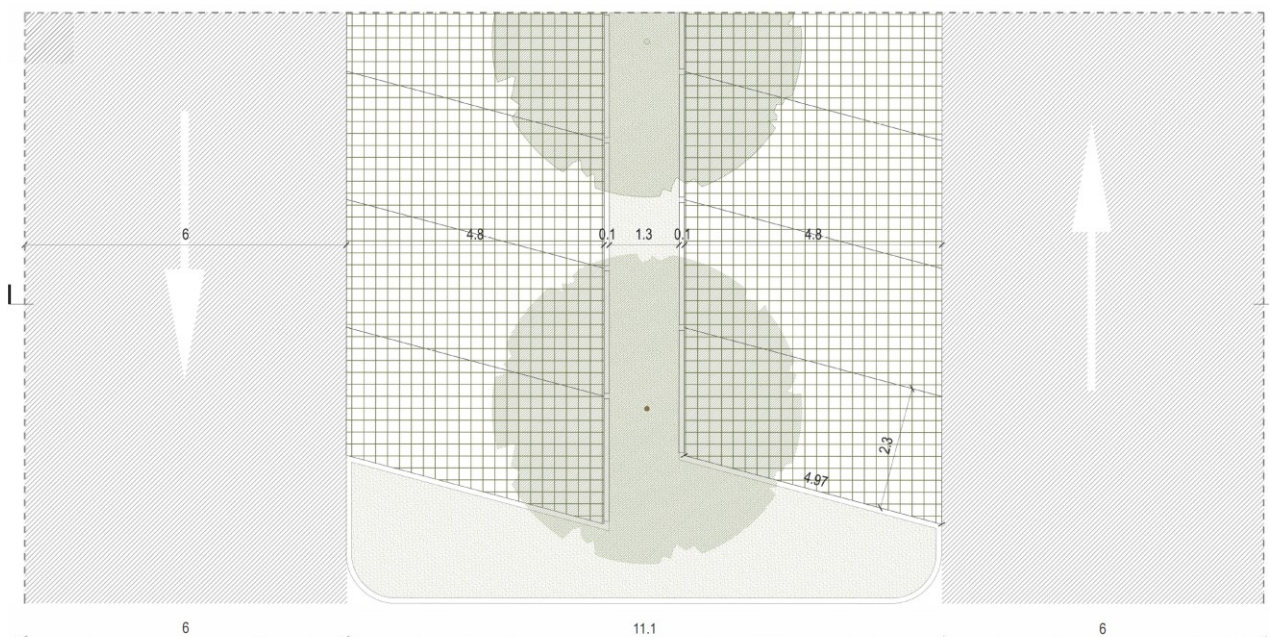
Stralcio Pianta Parcheggio nord – Progetto oggetto della procedura di Verifica di VIA
